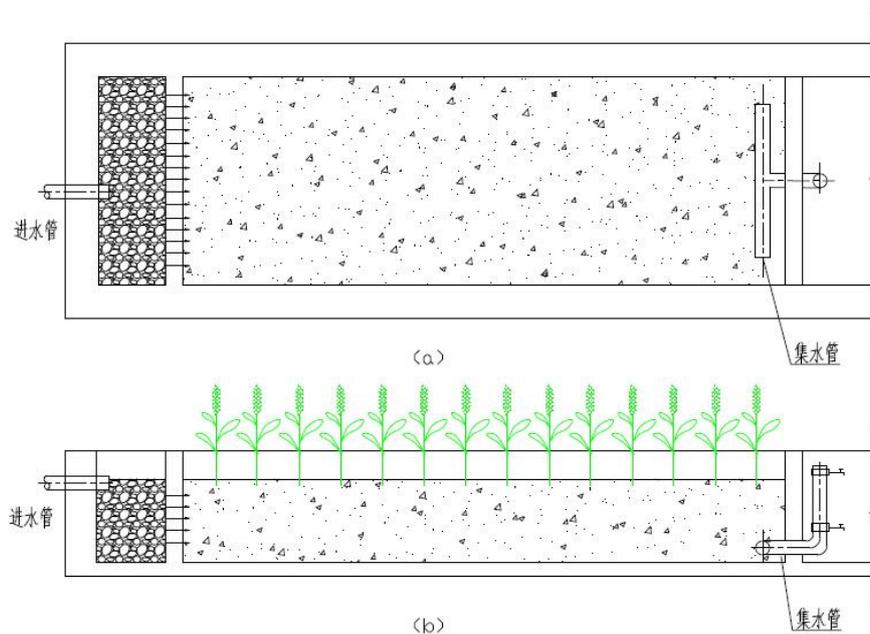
水平潜流人工湿地结构简图 (a) 平面图 (b) 剖面图
